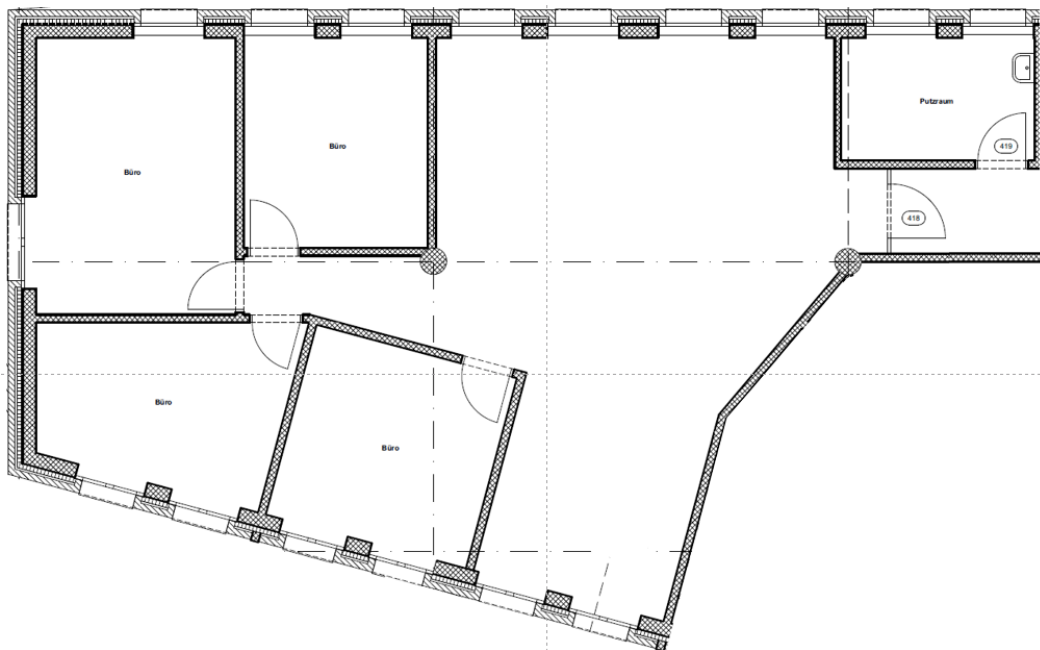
Grundriss freie Büroflächen 3.OG Malagagebäude
